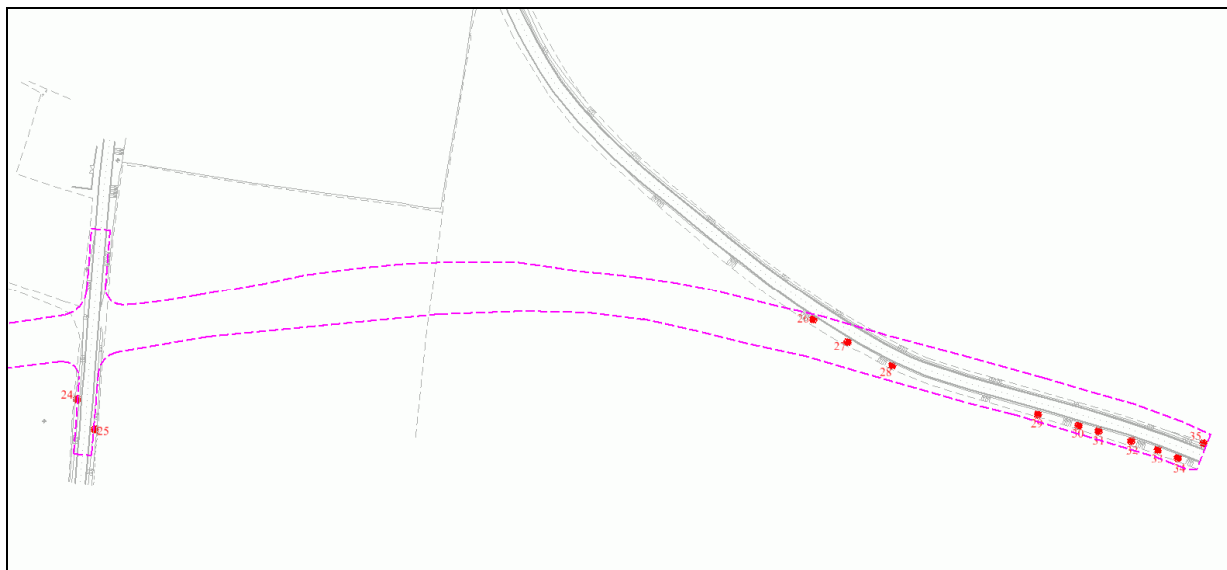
Mimolesní zeleň v km 0,0 – km 0,3
